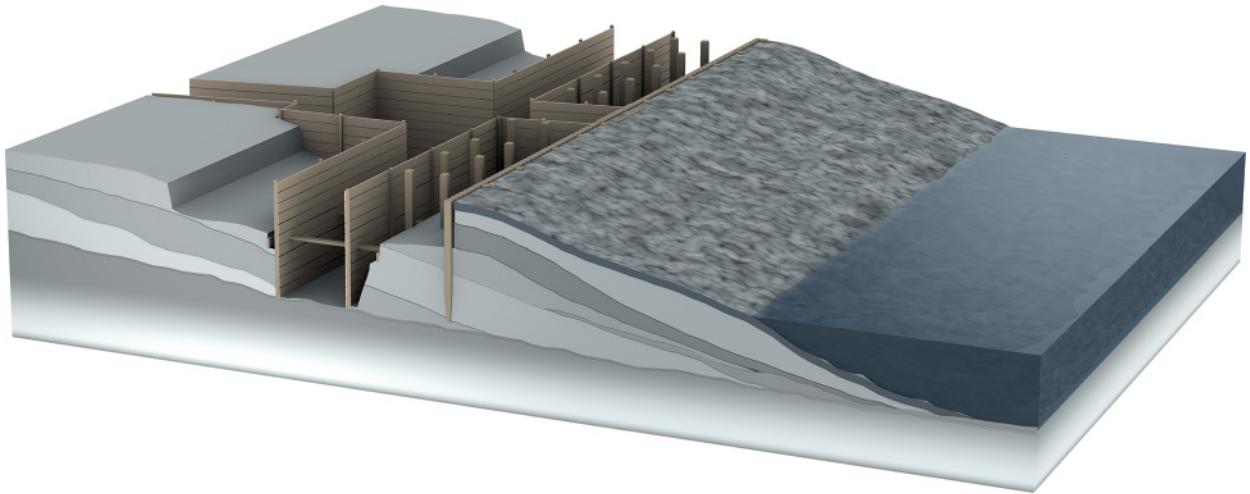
Digitale Rekonstruktion eines Bauabschnittes des römischen Hafentores von Köln. Fundamentgräben mit Blindverschalung und befestigter Schiffslände. – (RGM, digitale Rekonstruktion M. Eichhorn, M. Wallasch, Köln International School of Design, wiss. Koordination A. Schäfer).
